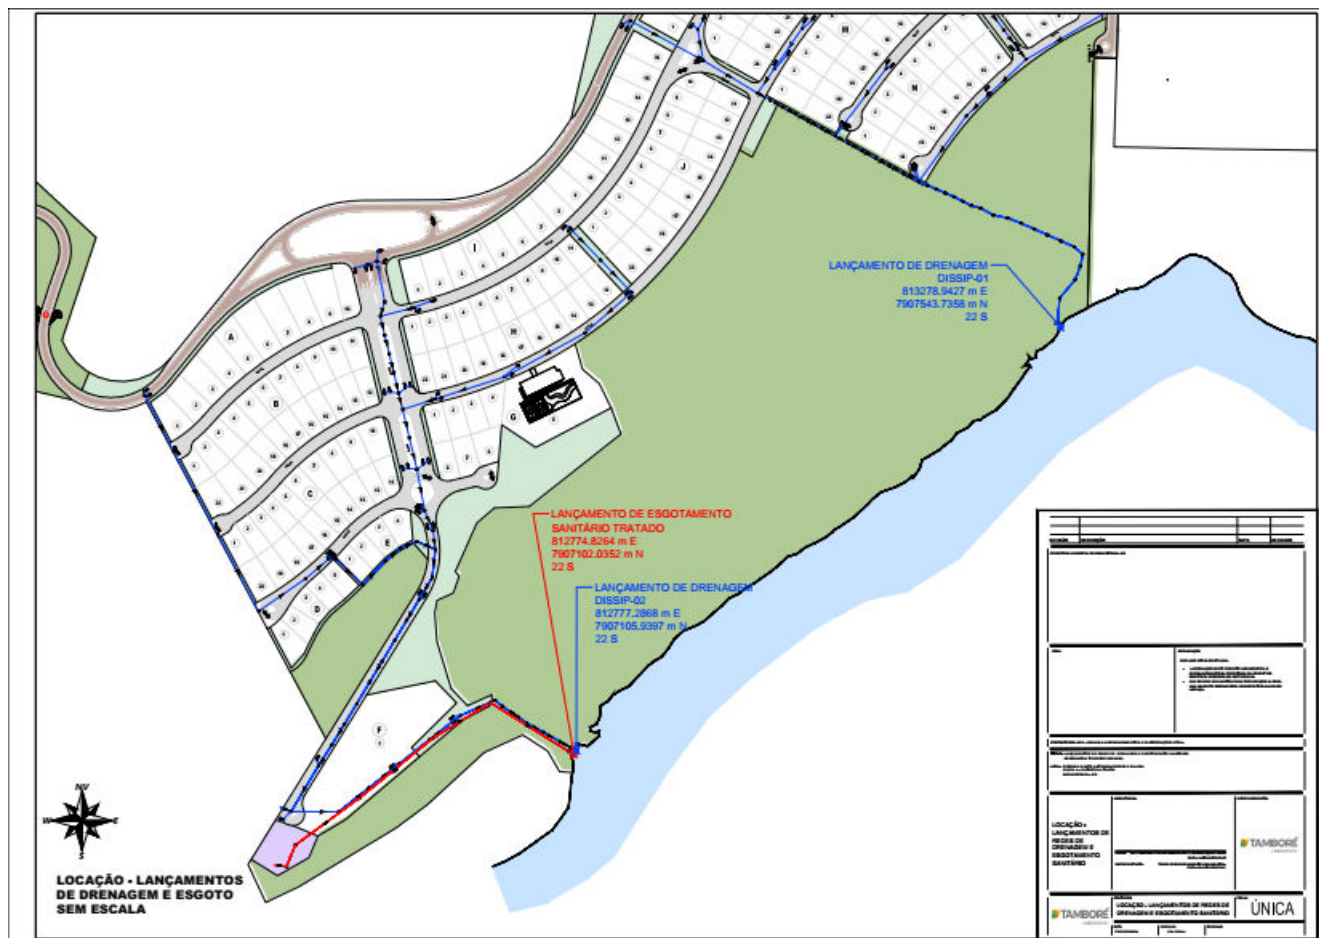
Lançamentos de drenagem pluvial e esgotamento sanitário.
